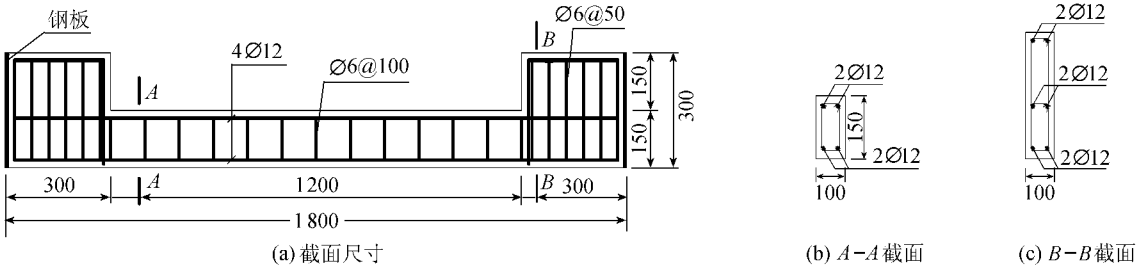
钢筋混凝土柱截面尺寸及钢筋布置(单位 :mm)
